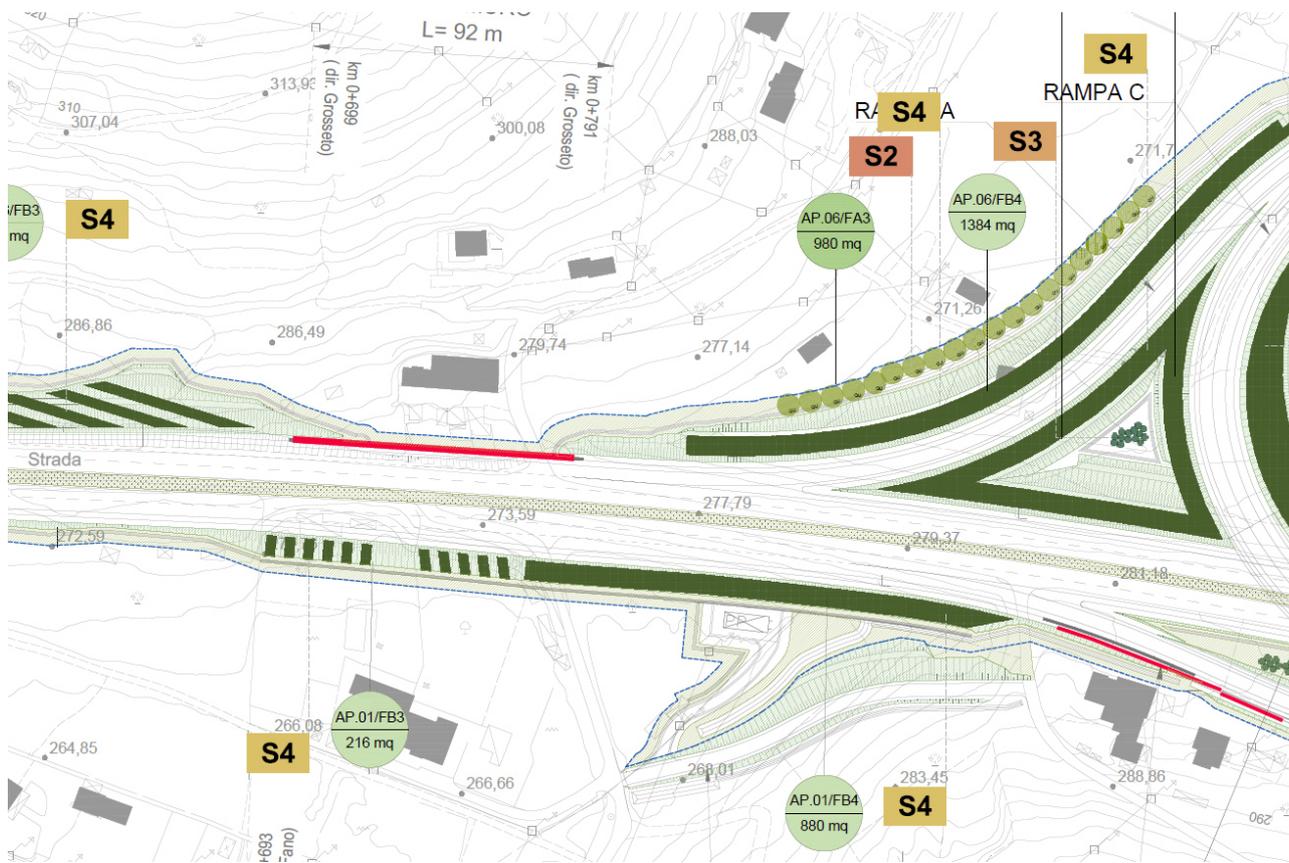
Stralcio della planimetria delle opere a verde, in corrispondenza all’area di pianura urbanizzata in dello svincolo “Stadio”
